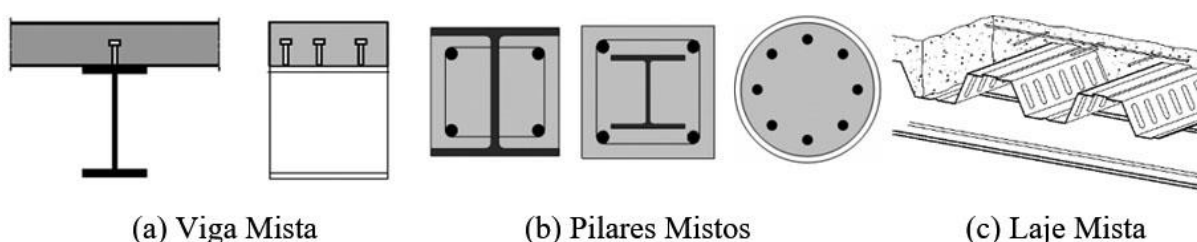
Elementos Mistos (NEWSTEELCONSTRUCTION@ sem data)
